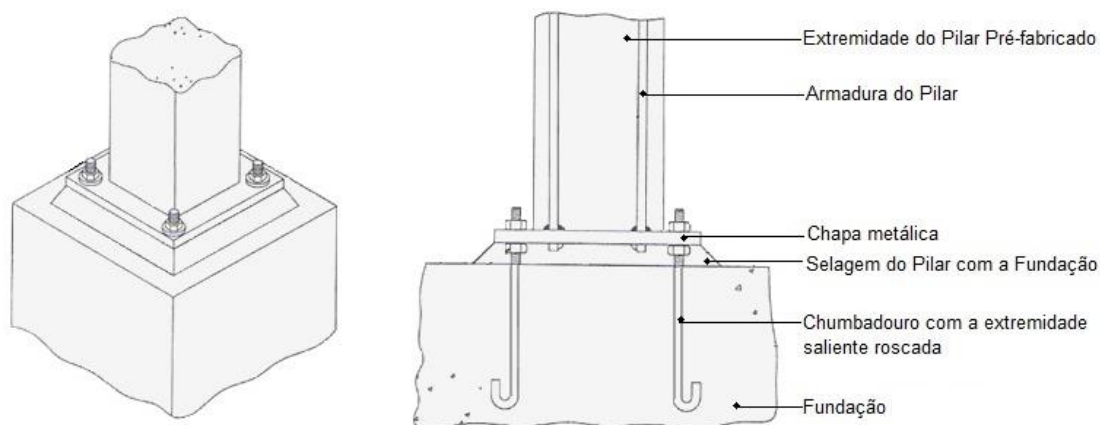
Ligação Pilar – Fundação por chapa aparafusada [46]
